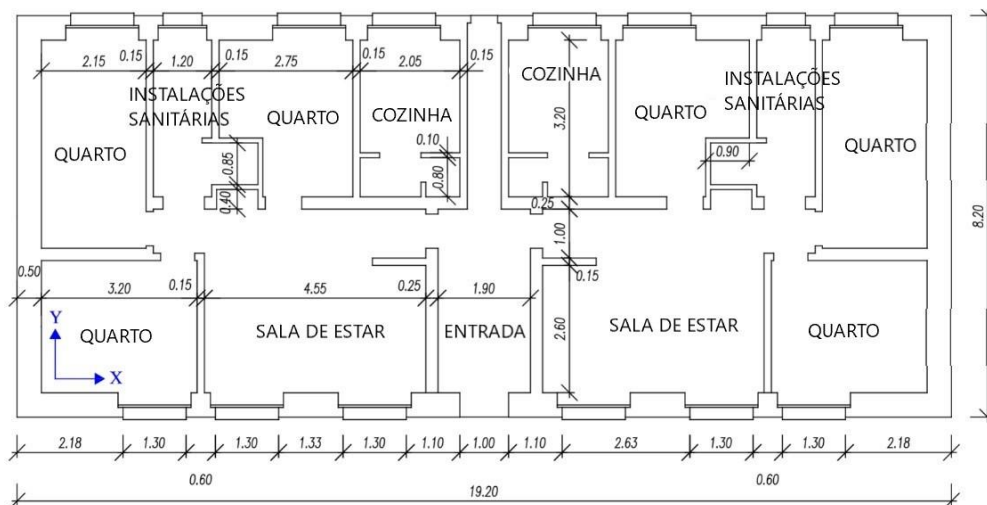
9- Planta do piso térreo do edifício em estudo, dimensões em m, adaptado de (Lamego et al., 2017).
